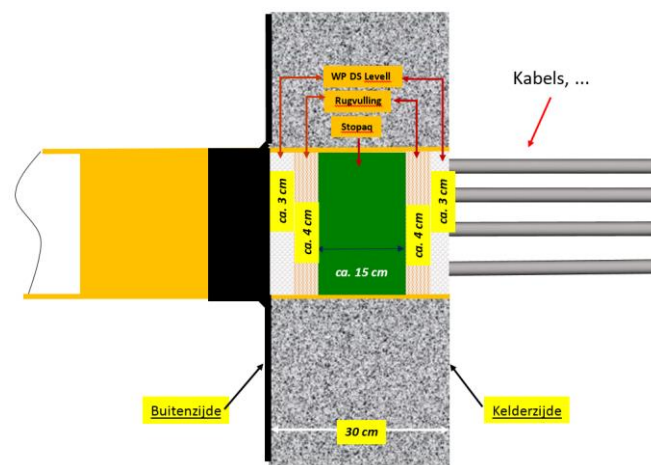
detail waterdichting buisdoorvoer - afdichting in de buis
